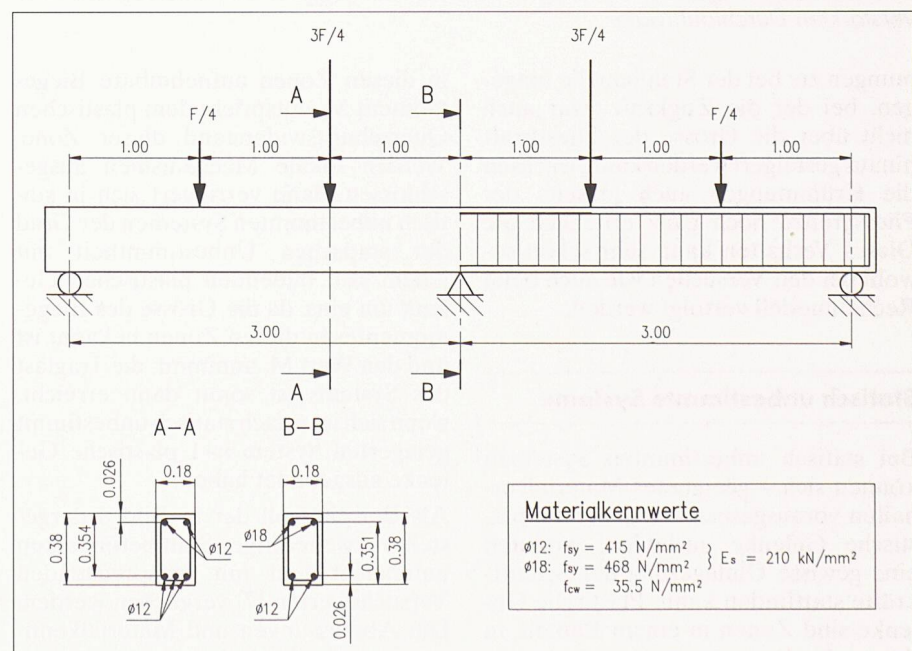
Abmessungen, Bewehrungs- und Lastanordnung des untersuchten Stahlbetondurchlaufträgers
